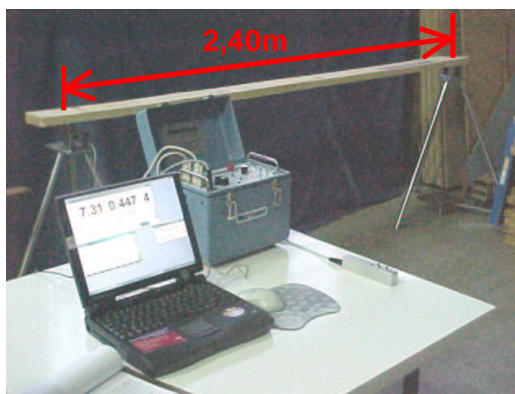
Equipamento de vibração transversal utilizado nos testes.
